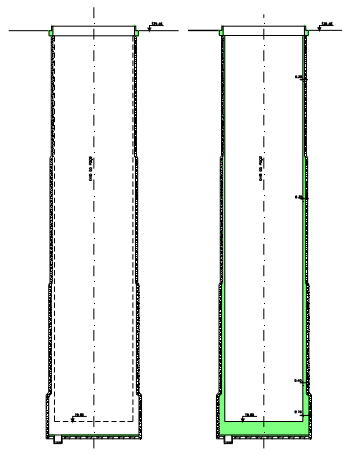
Esquema dos trabalhos preliminares e configuração final da laje de fundo – Poço de Ventilação
